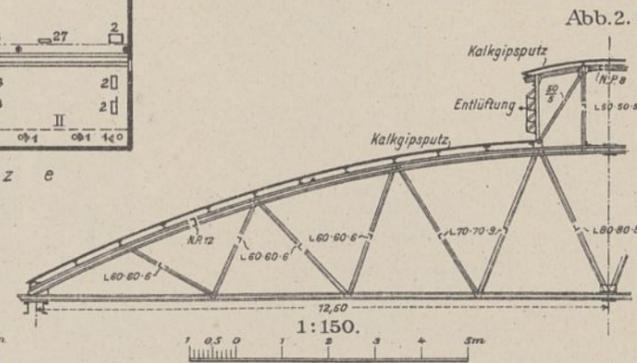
Dach der Mittelhalle der Brückenbauwerkstatt. 1: 150.
